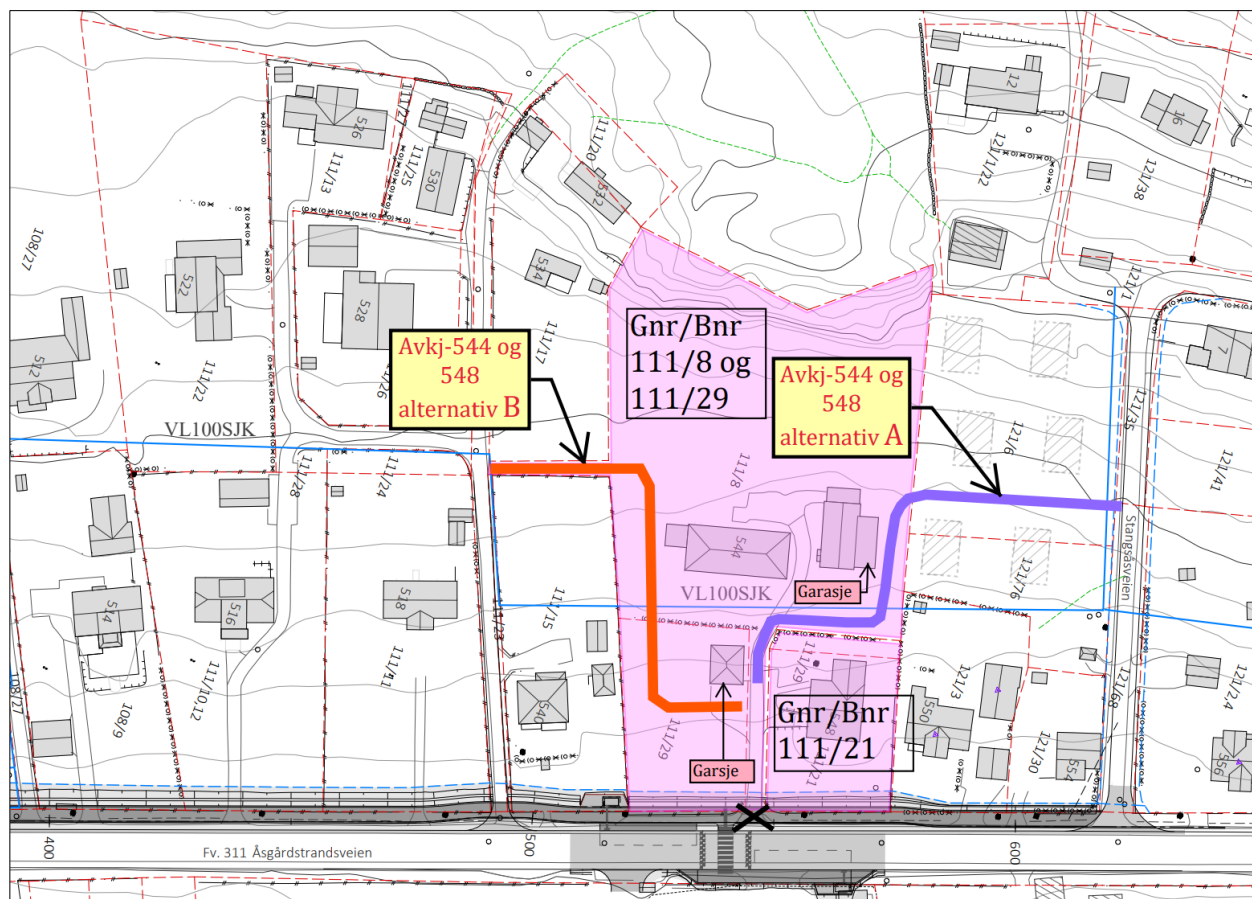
Felles privat adkomstveg, kryss mot fv.311. Foto - VTFK.
